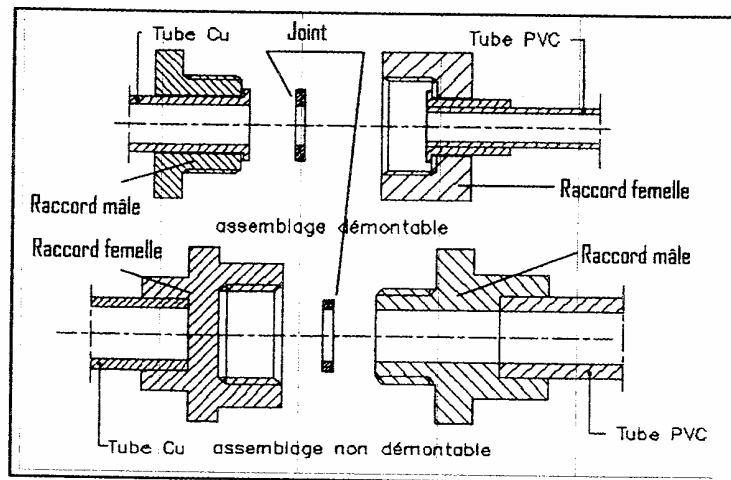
Assemblage tube cuivre 1 tube PVC par raccords
